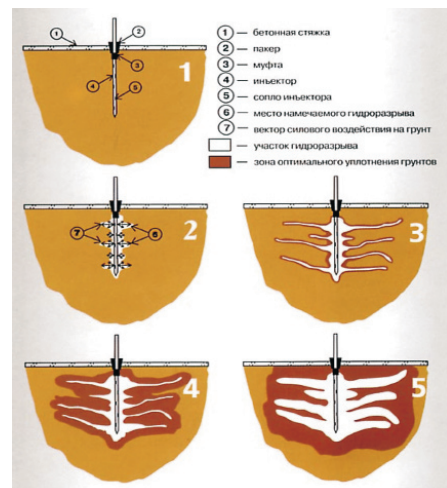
Схема армирования грунтового массива твердеющими растворами
